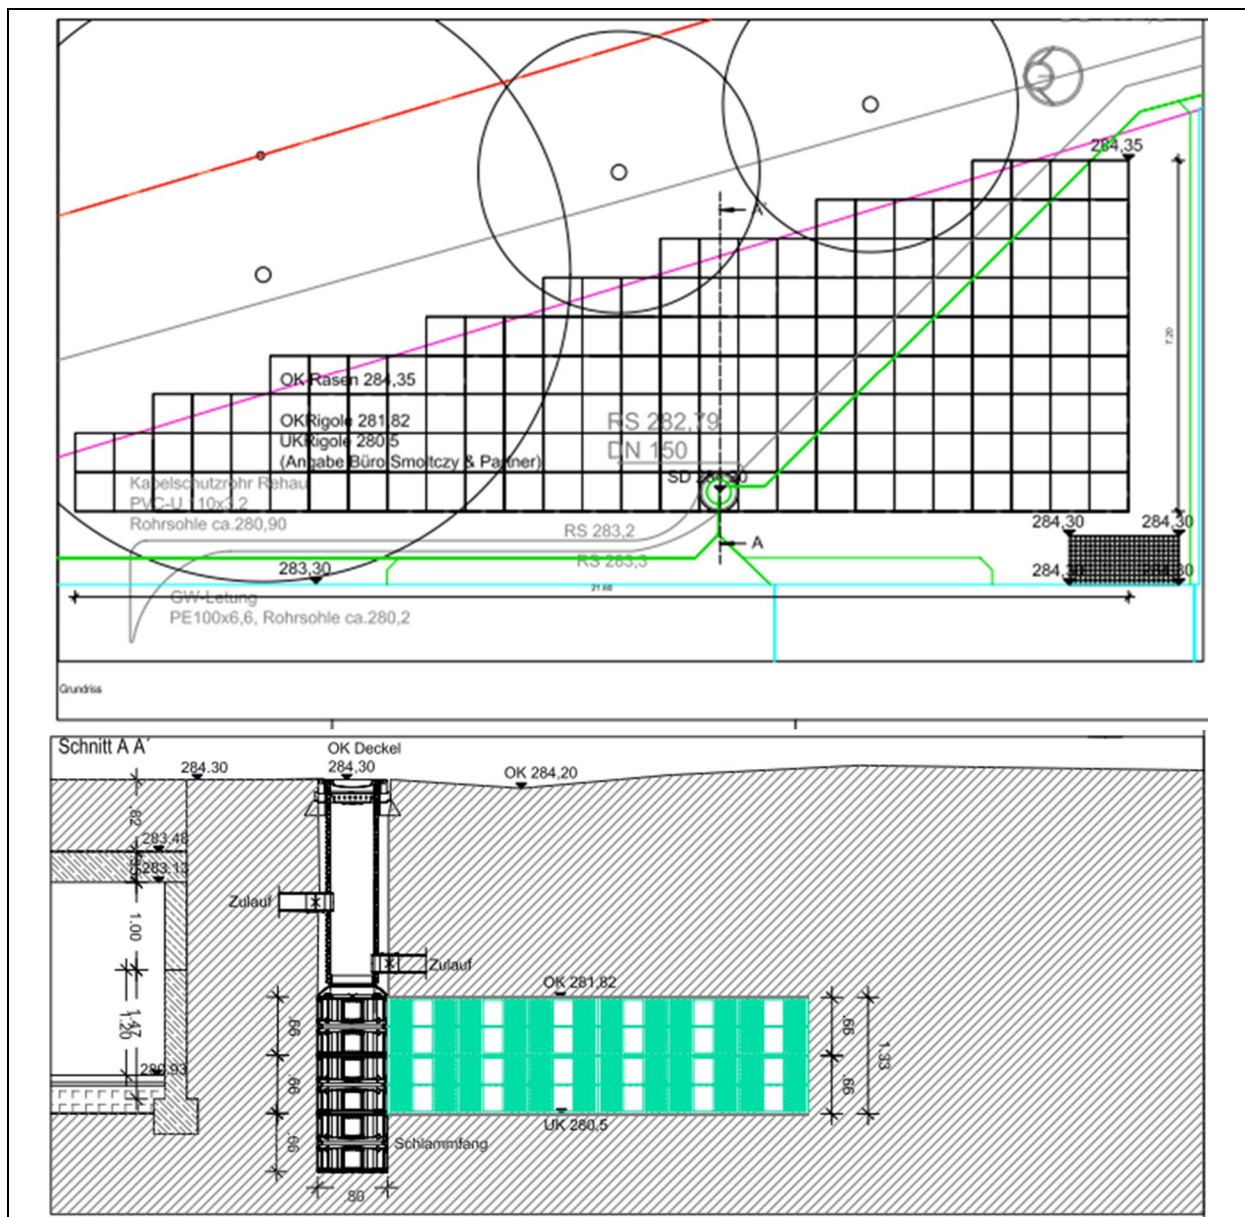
Ausführungspläne der Rigole zur Grundwasserversickerung (Grundriss und Schnitt)
